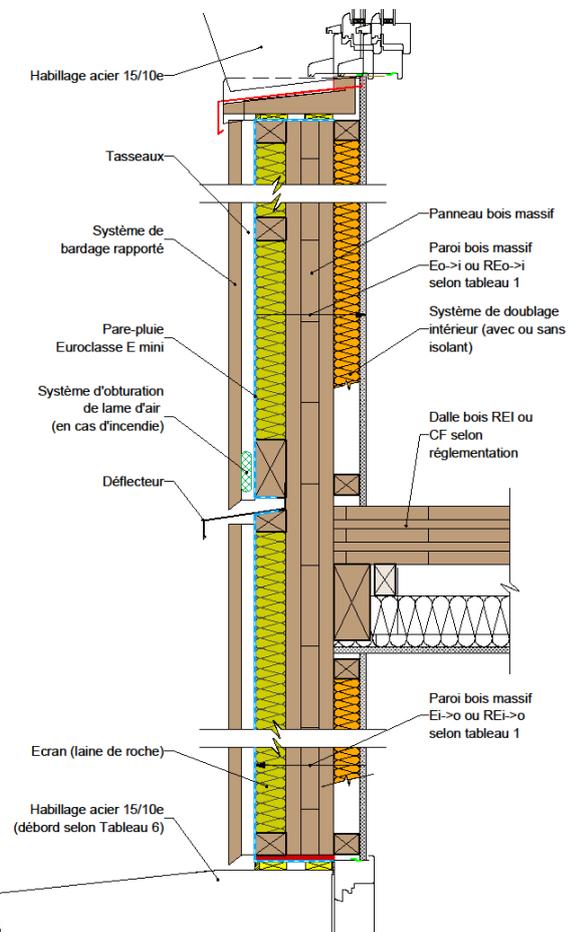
Façade/mur en panneaux bois massif & plancher en panneaux bois massif.
